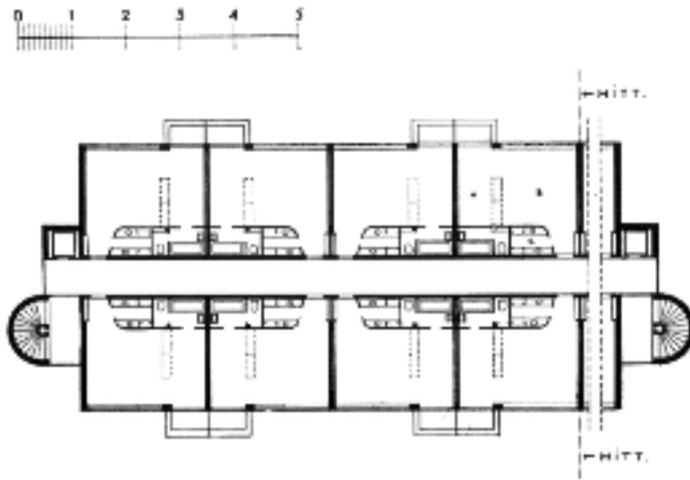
Erik Friberger: Grundrisse der Mietwohnung 15.
